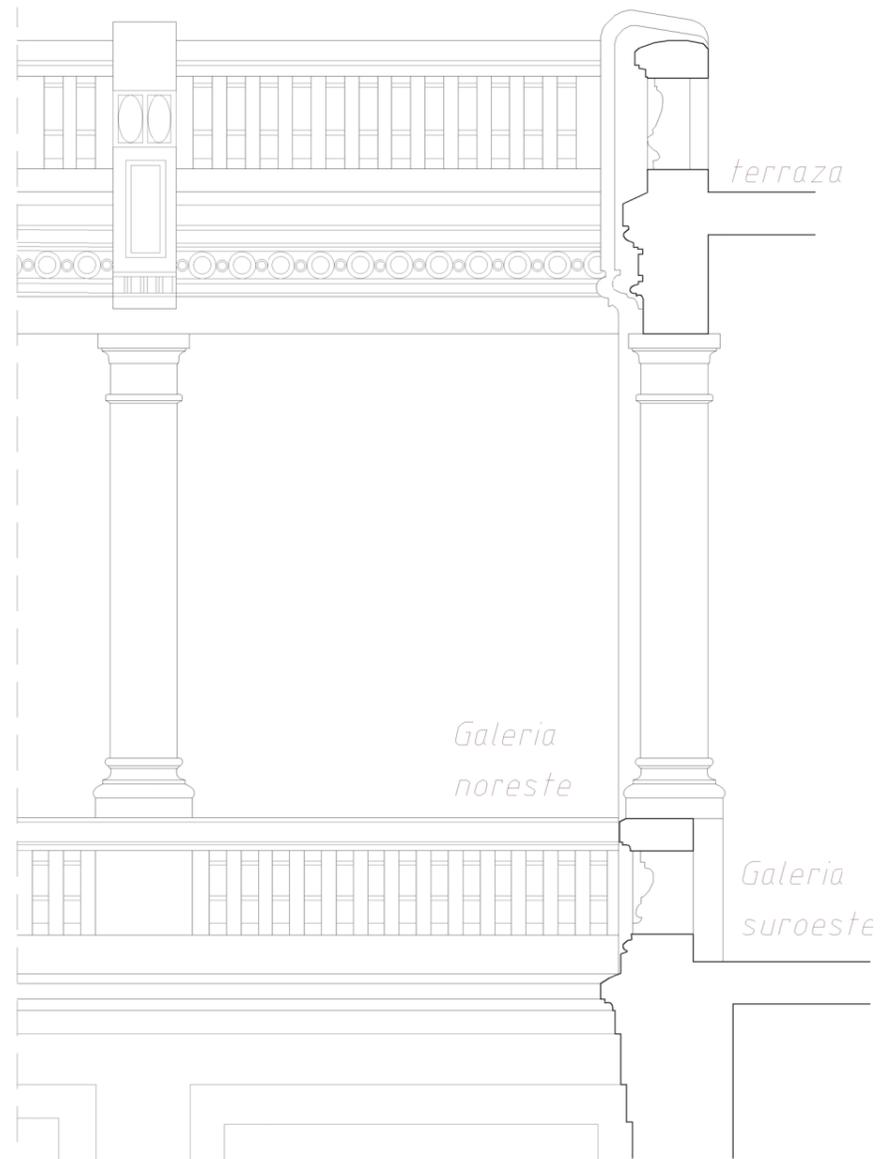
Detalle de fachada dibujado a partir de los planos del archivo municipal del ayuntamiento de Getxo.
